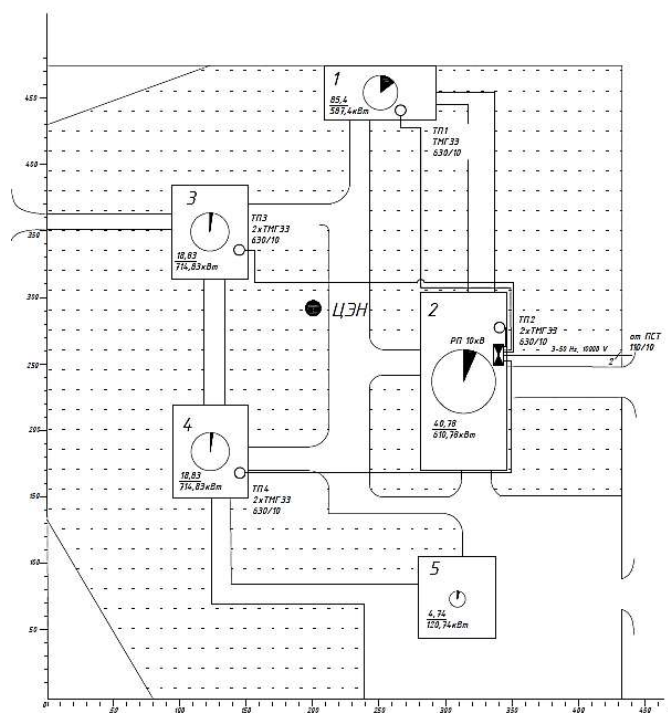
Схема электроснабжения на генплане завода 2-го варианта
